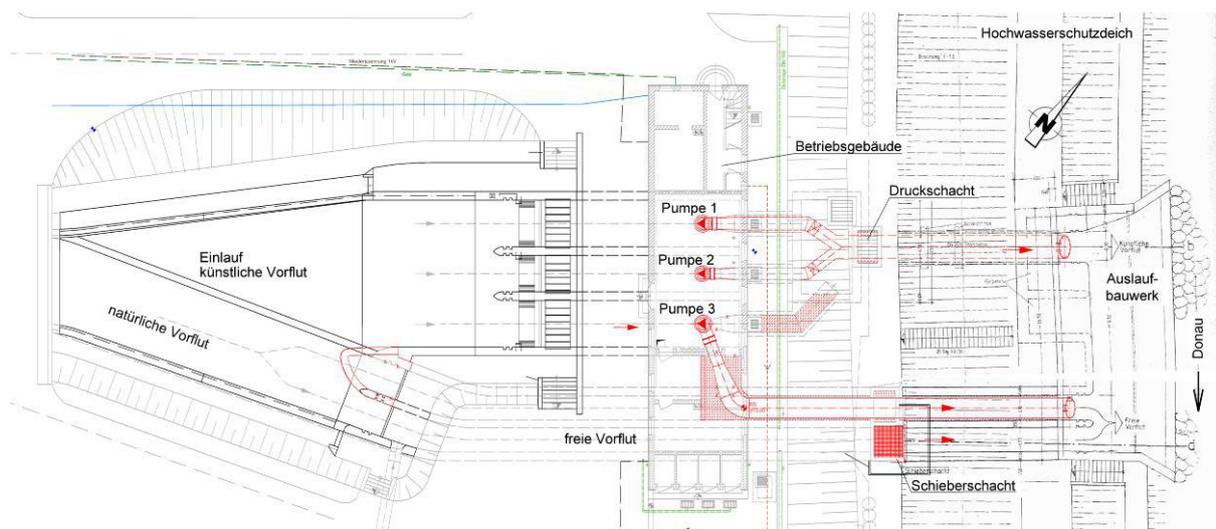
Lageplanausschnitt mit vorhandenen Bauwerken und den geplanten Neu- bzw. Umbauten (rot)
